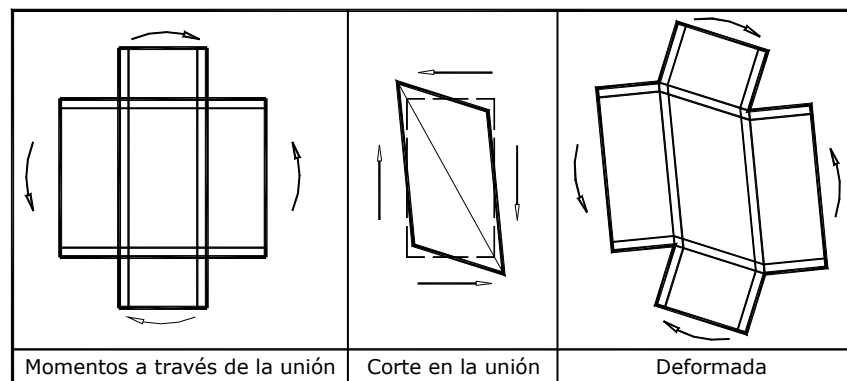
Distorsión en una conexión viga columna no rígida.
